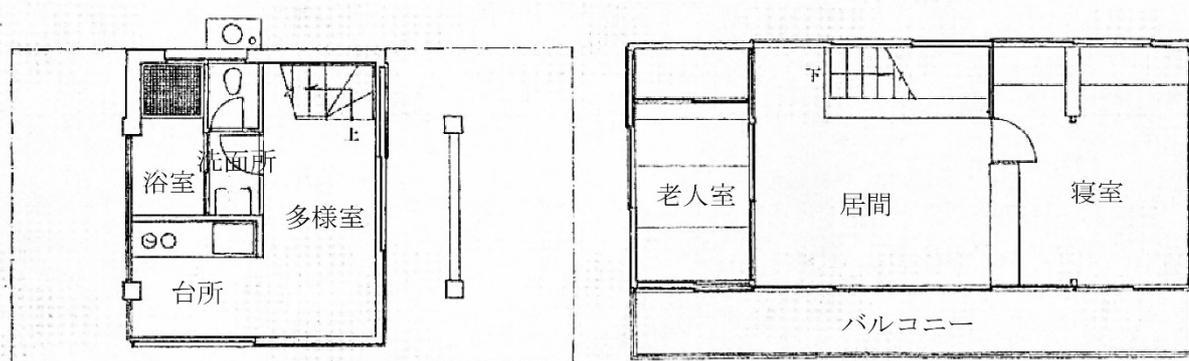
「SH-16」(1958) 各階平面図 (左:1階平面図 右:2階平面図)
